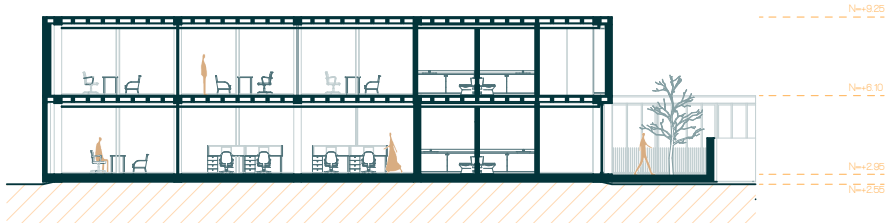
Sección C-C, Bloque B (Autores, 2023)
